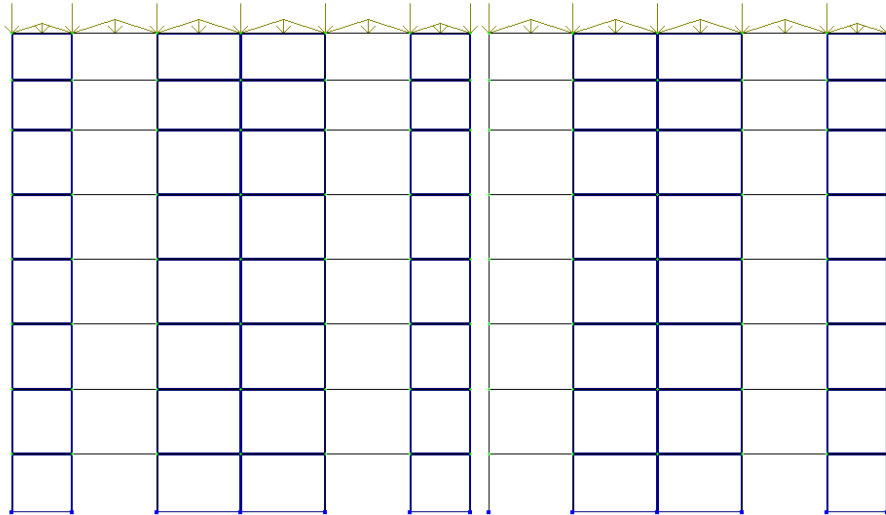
Схема завантаження, від снігового навантаження
